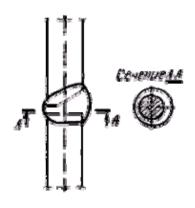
Соединение стыковое со скосом верхнего стержня. Тип 6
